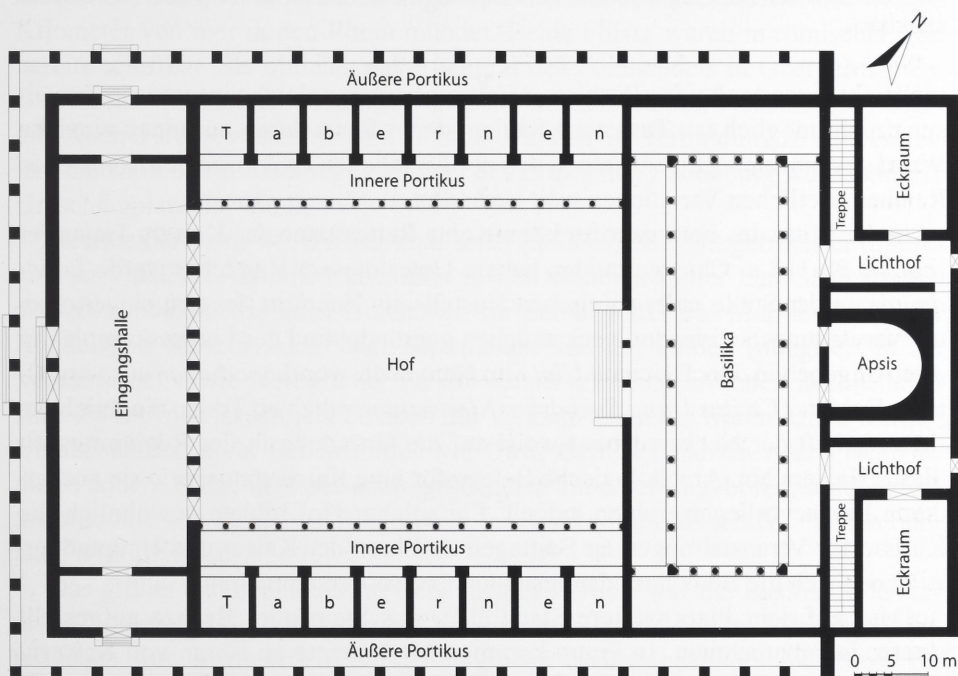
Grundriss des Forums. M. 1:1000.
